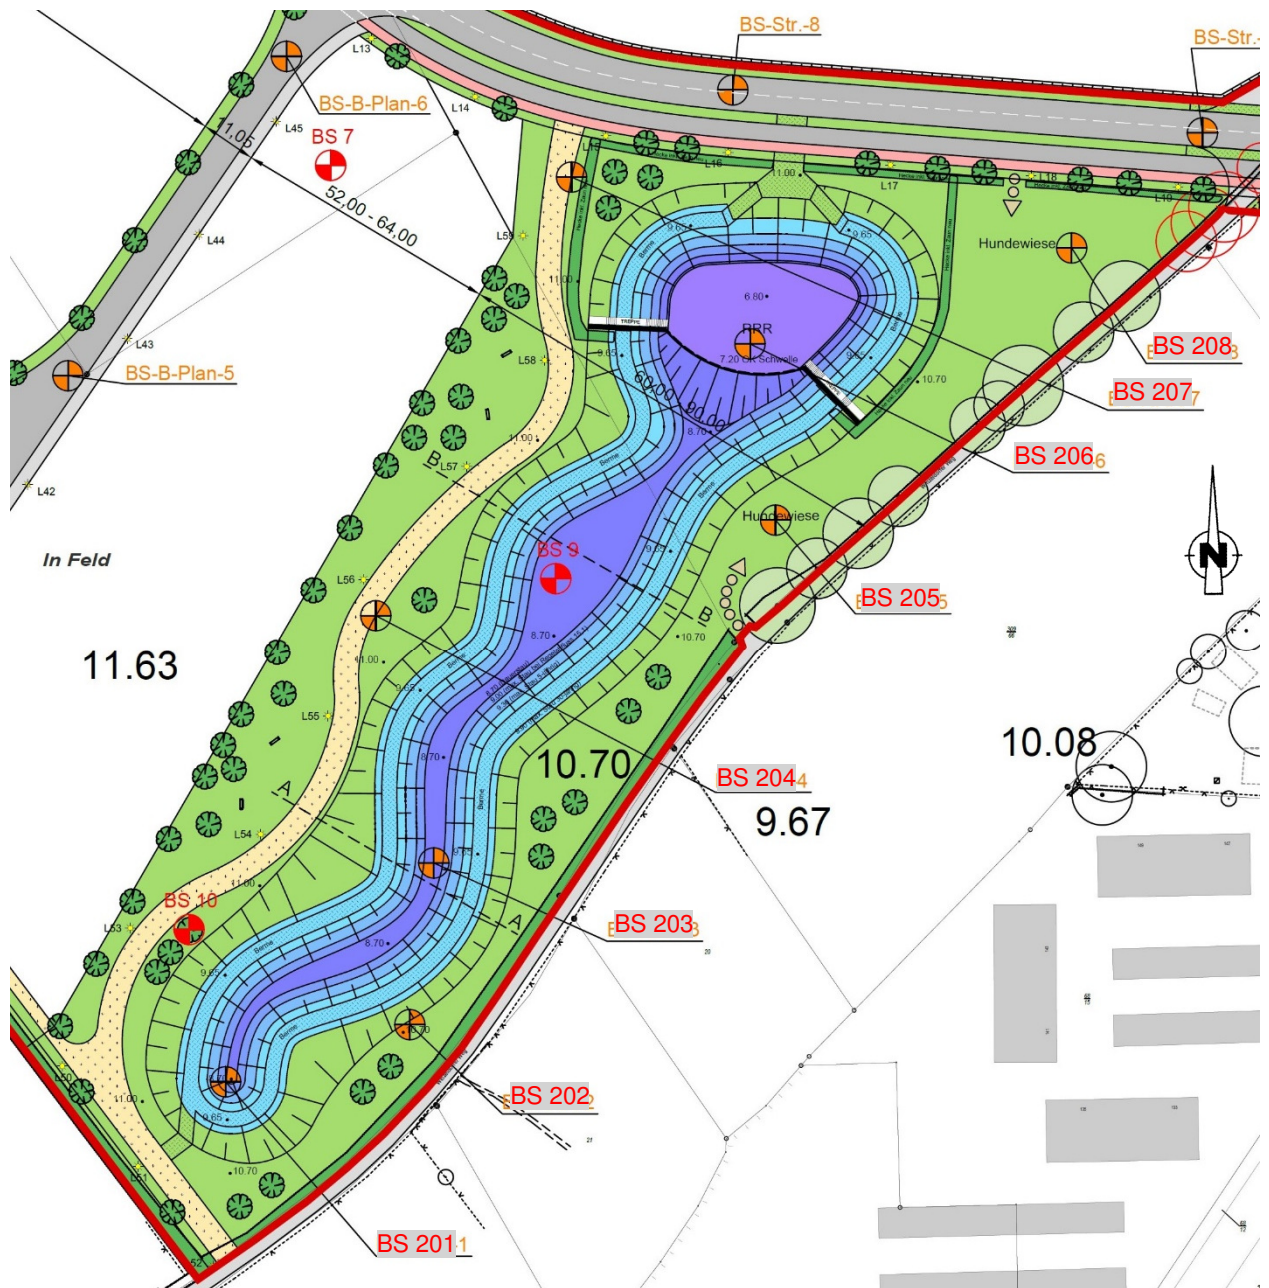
Lageplan Regenrückhalteraum (RRR), M 1:1500
